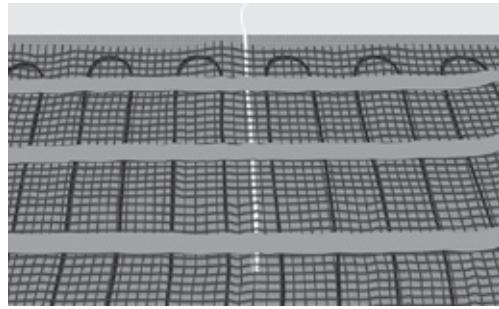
Placer le tuyau de conduit/capteur entre les câbles
